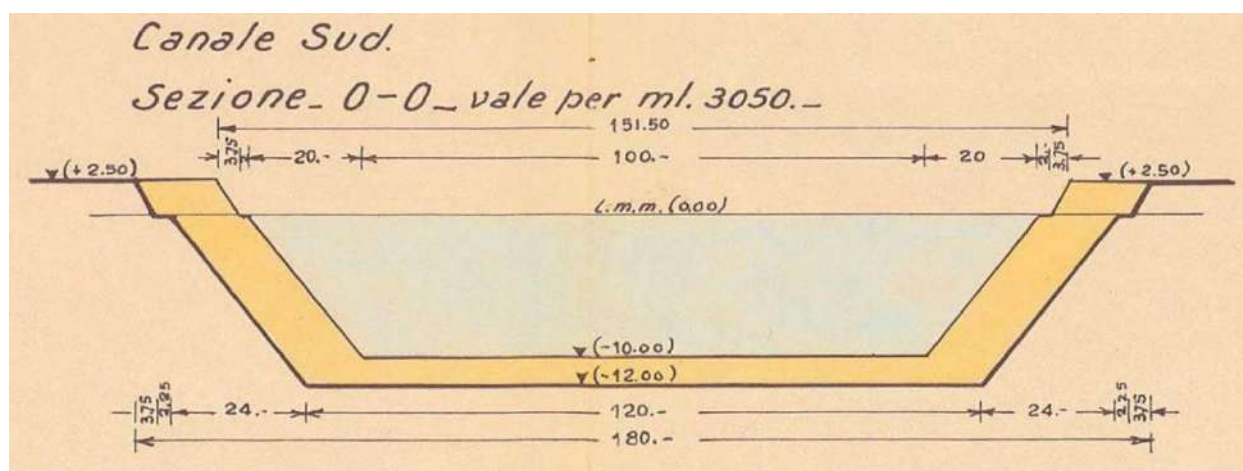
Estratto PRP 1965 – Sezione 0-0
